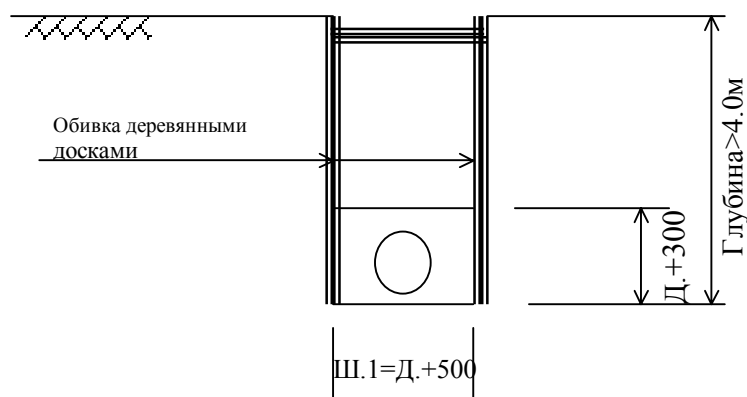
Общий разрез выработки грунта до глубины, превышающей 4.0 м
